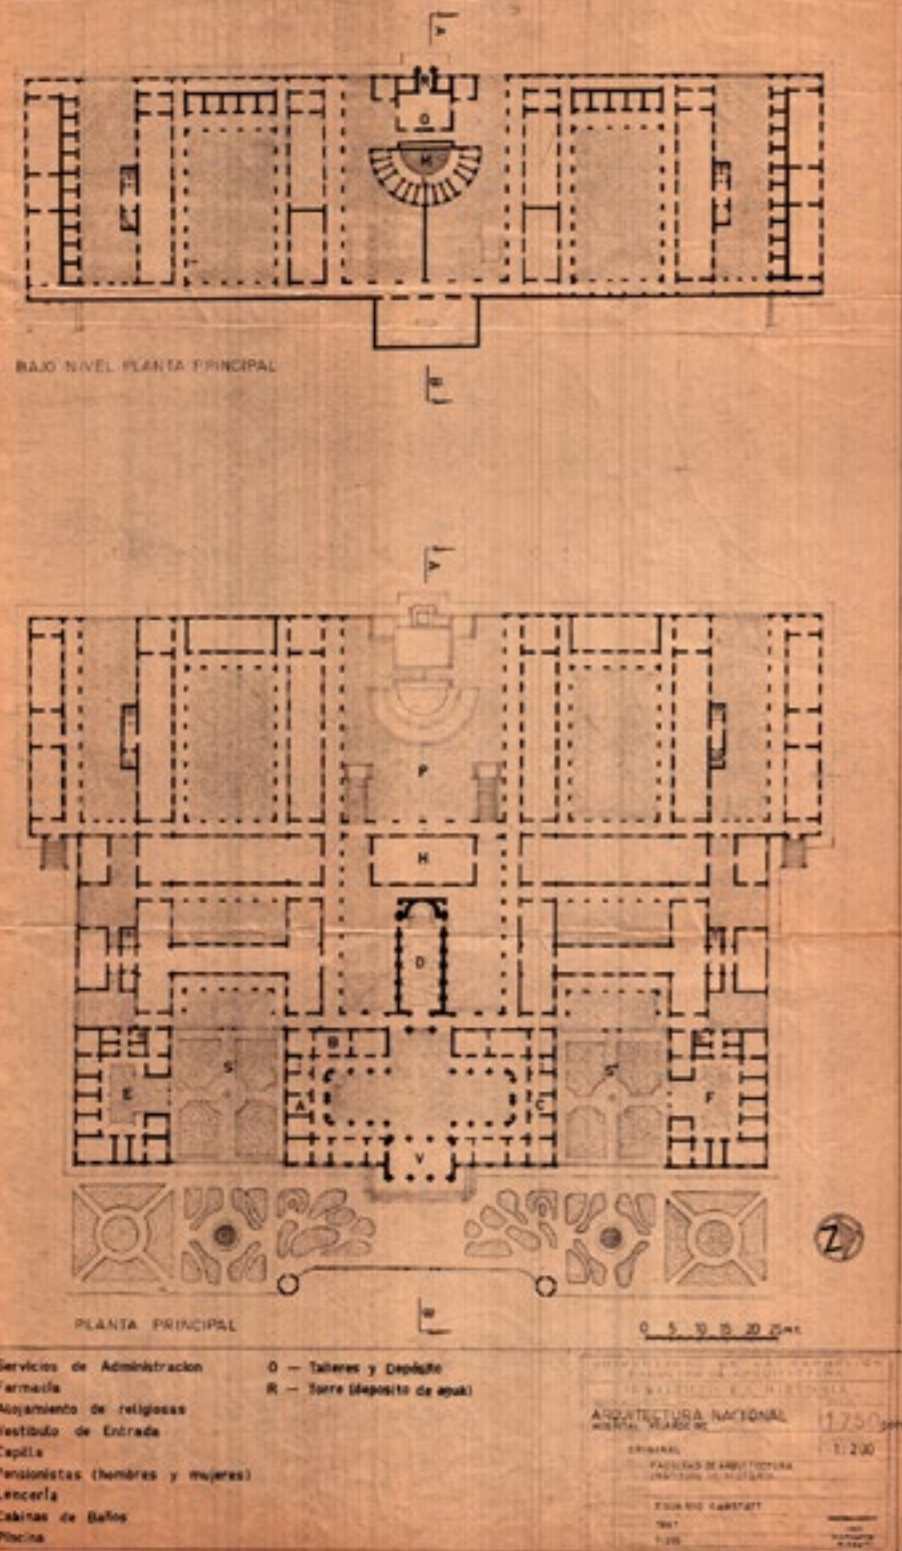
Ing. Eduardo Canstatt. Planta del Manicomio Nacional (1876-1880).
